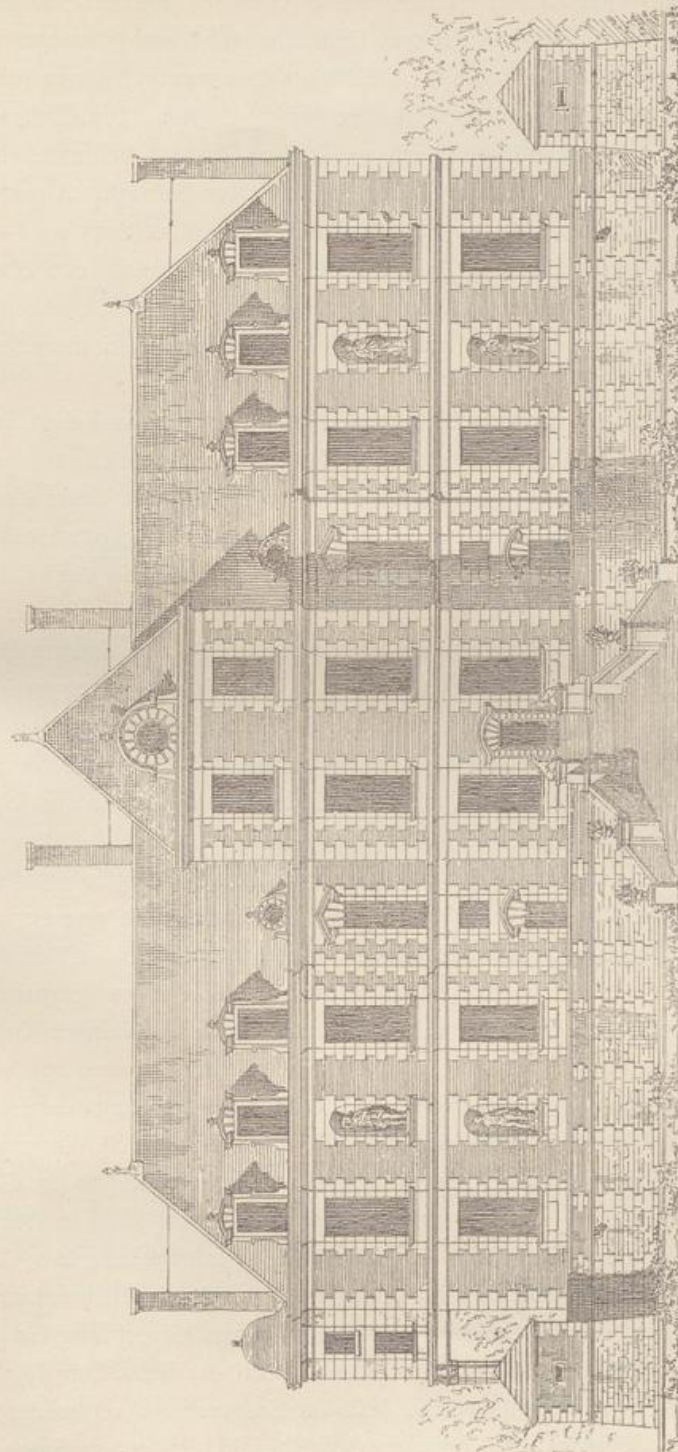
Château de Wideville. Parkfaçade (n. Sauvageot).
